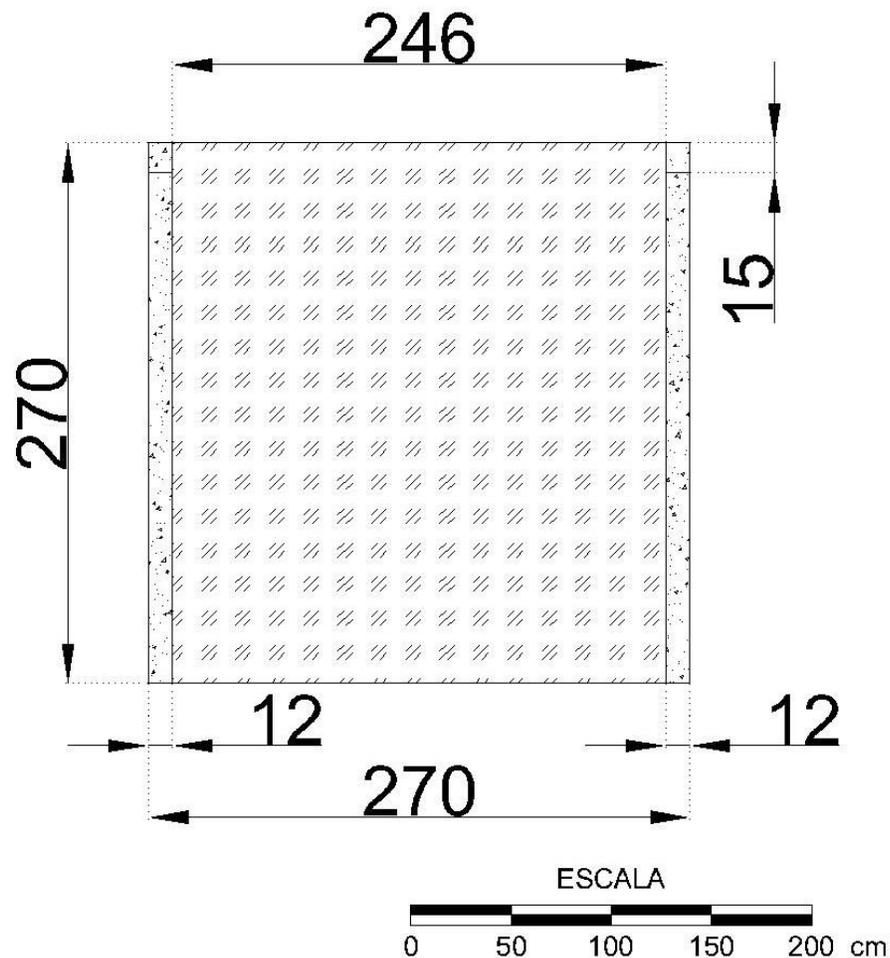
Alzado Muros con Paneles de Yeso Intermedios.
